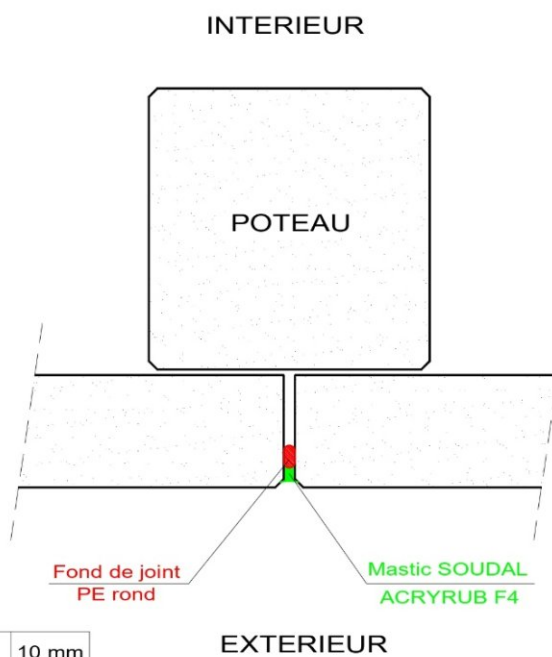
DETAIL DES JOINTS HORIZONTAUX NON COUPE-FEU
